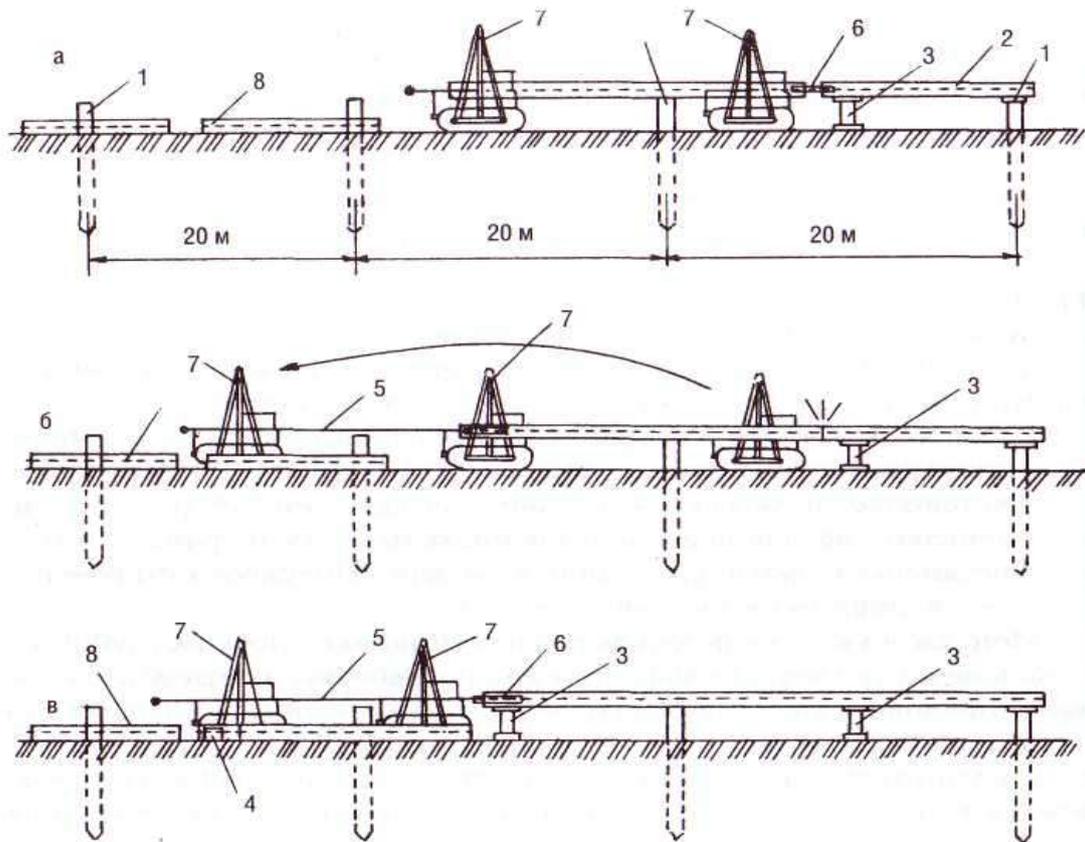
Монтаж плетей на опорах: а— сборка стыка; б — перемещение центриатора; в — подготовка трубы к стыковке; 1 — опора; 2 — смонтированный трубопровод; 3 — монтажная опора; 4 — передвижная опора штанги; 5 — штанга; 6 — центриатор; 7 — трубоукладчик; 8 — трубы
